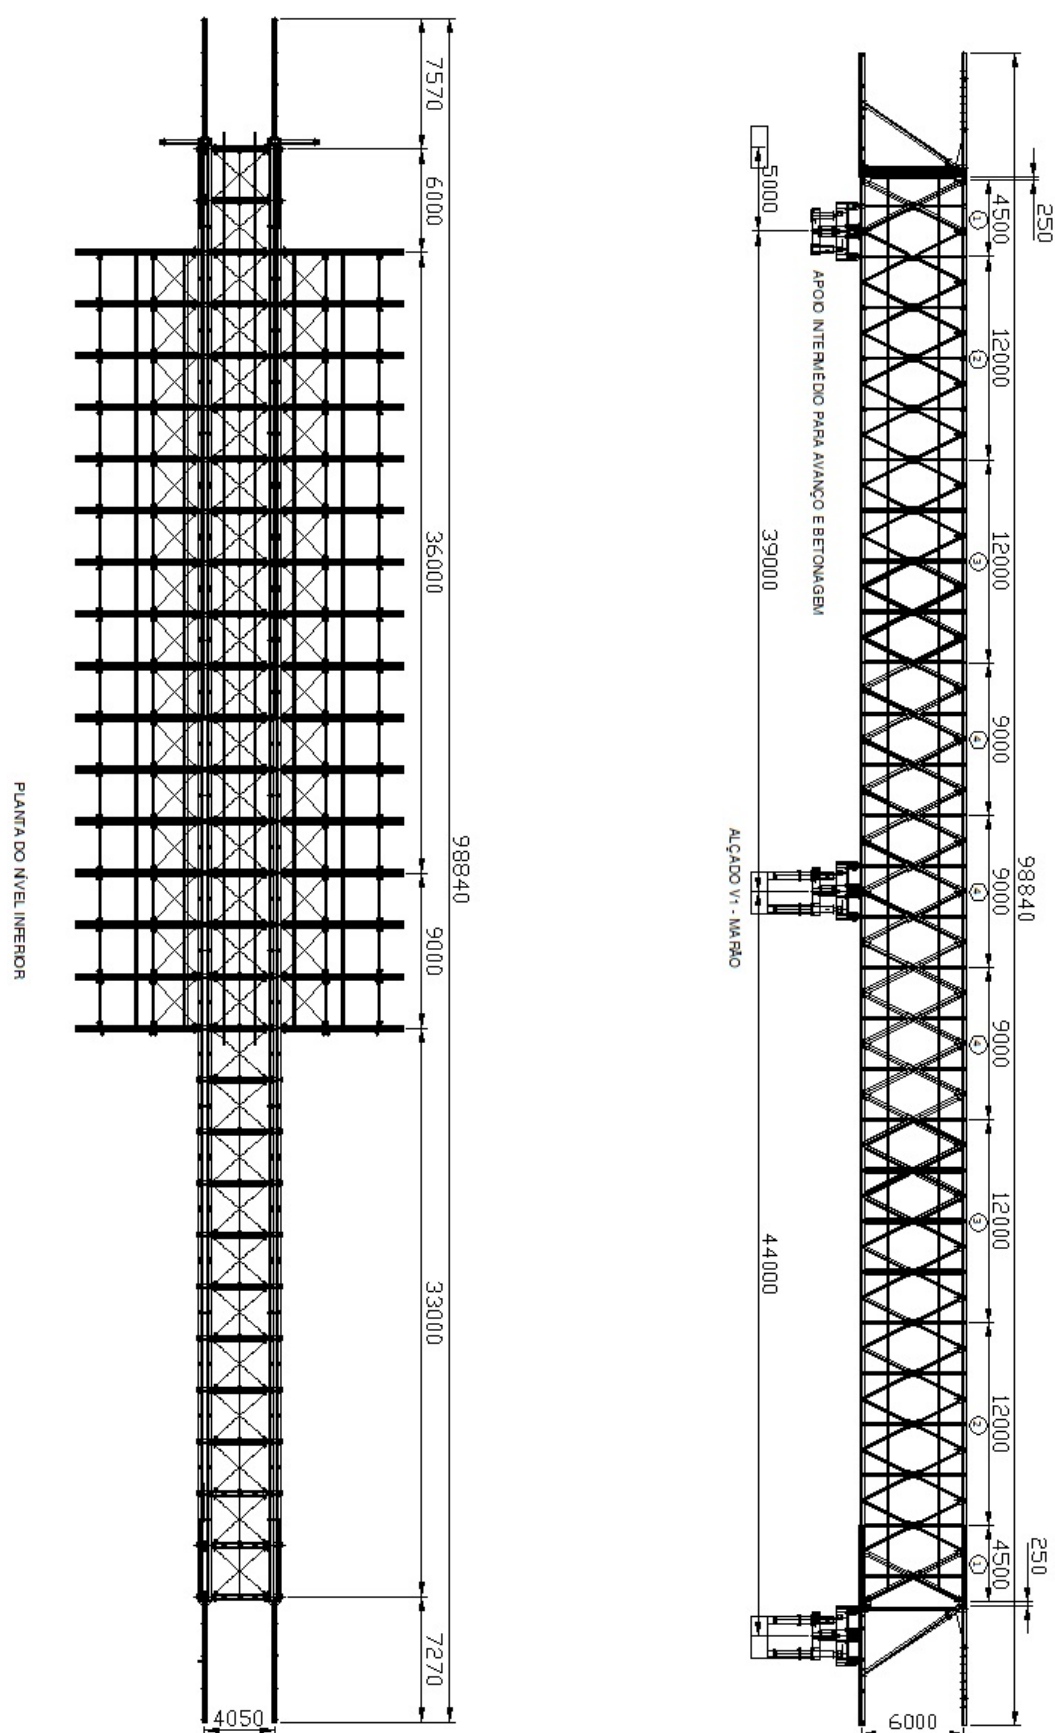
Alçado e planta da estrutura do cembre em estudo.
